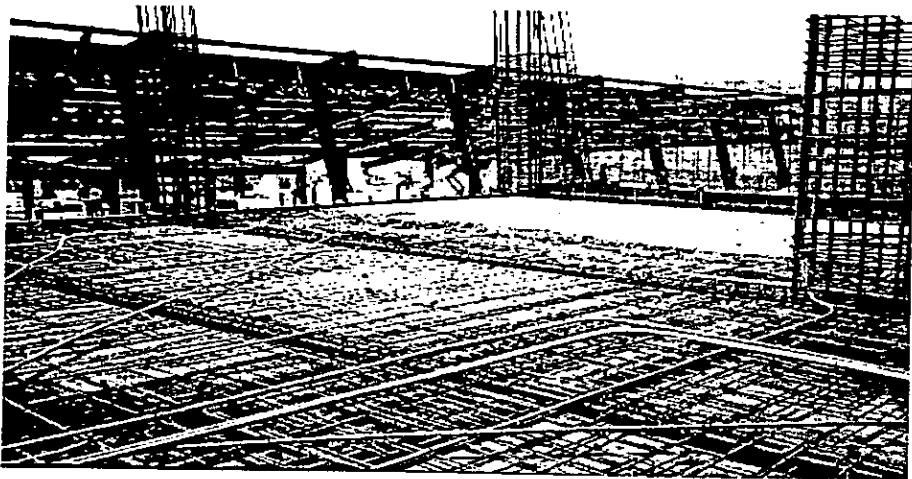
Armado de un sistema de piso de concreto reforzado
